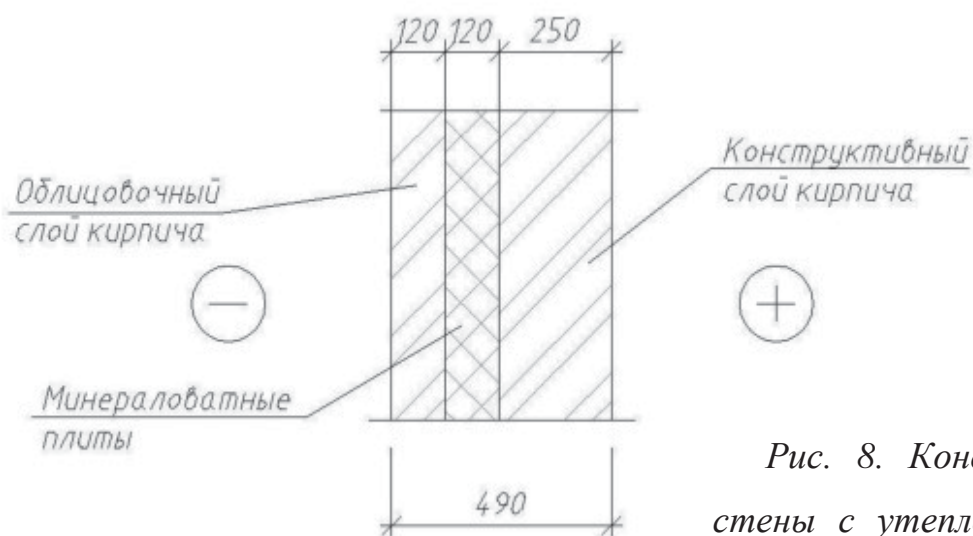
Конструкция кирпичной стены с утеплением и облицовкой кирпичом
